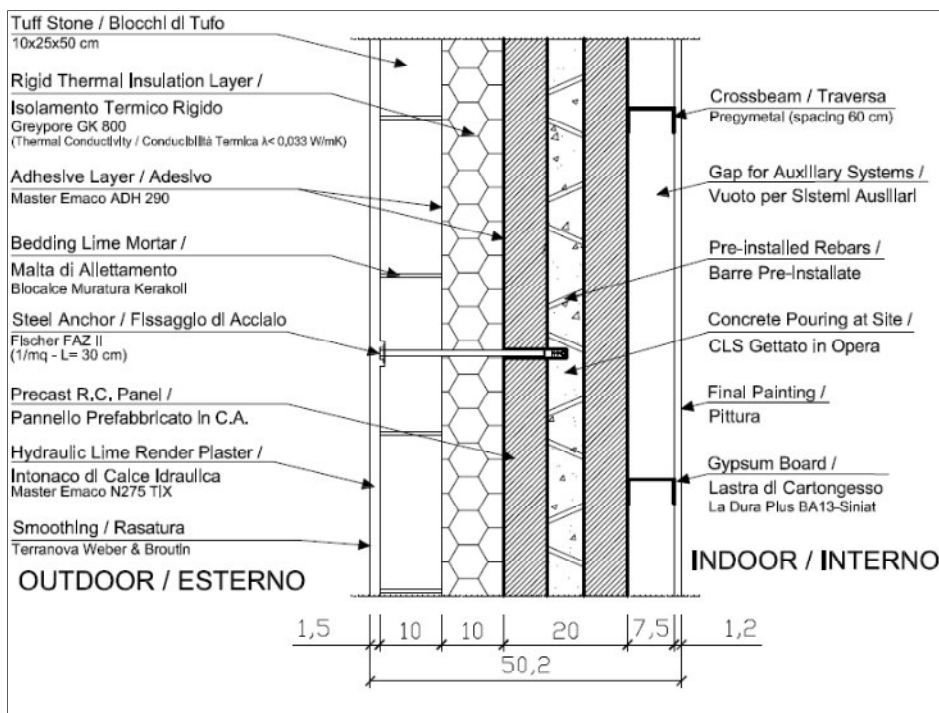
Sezione tipica muratura esterna portante con finitura a intonaco di calce idraulica
